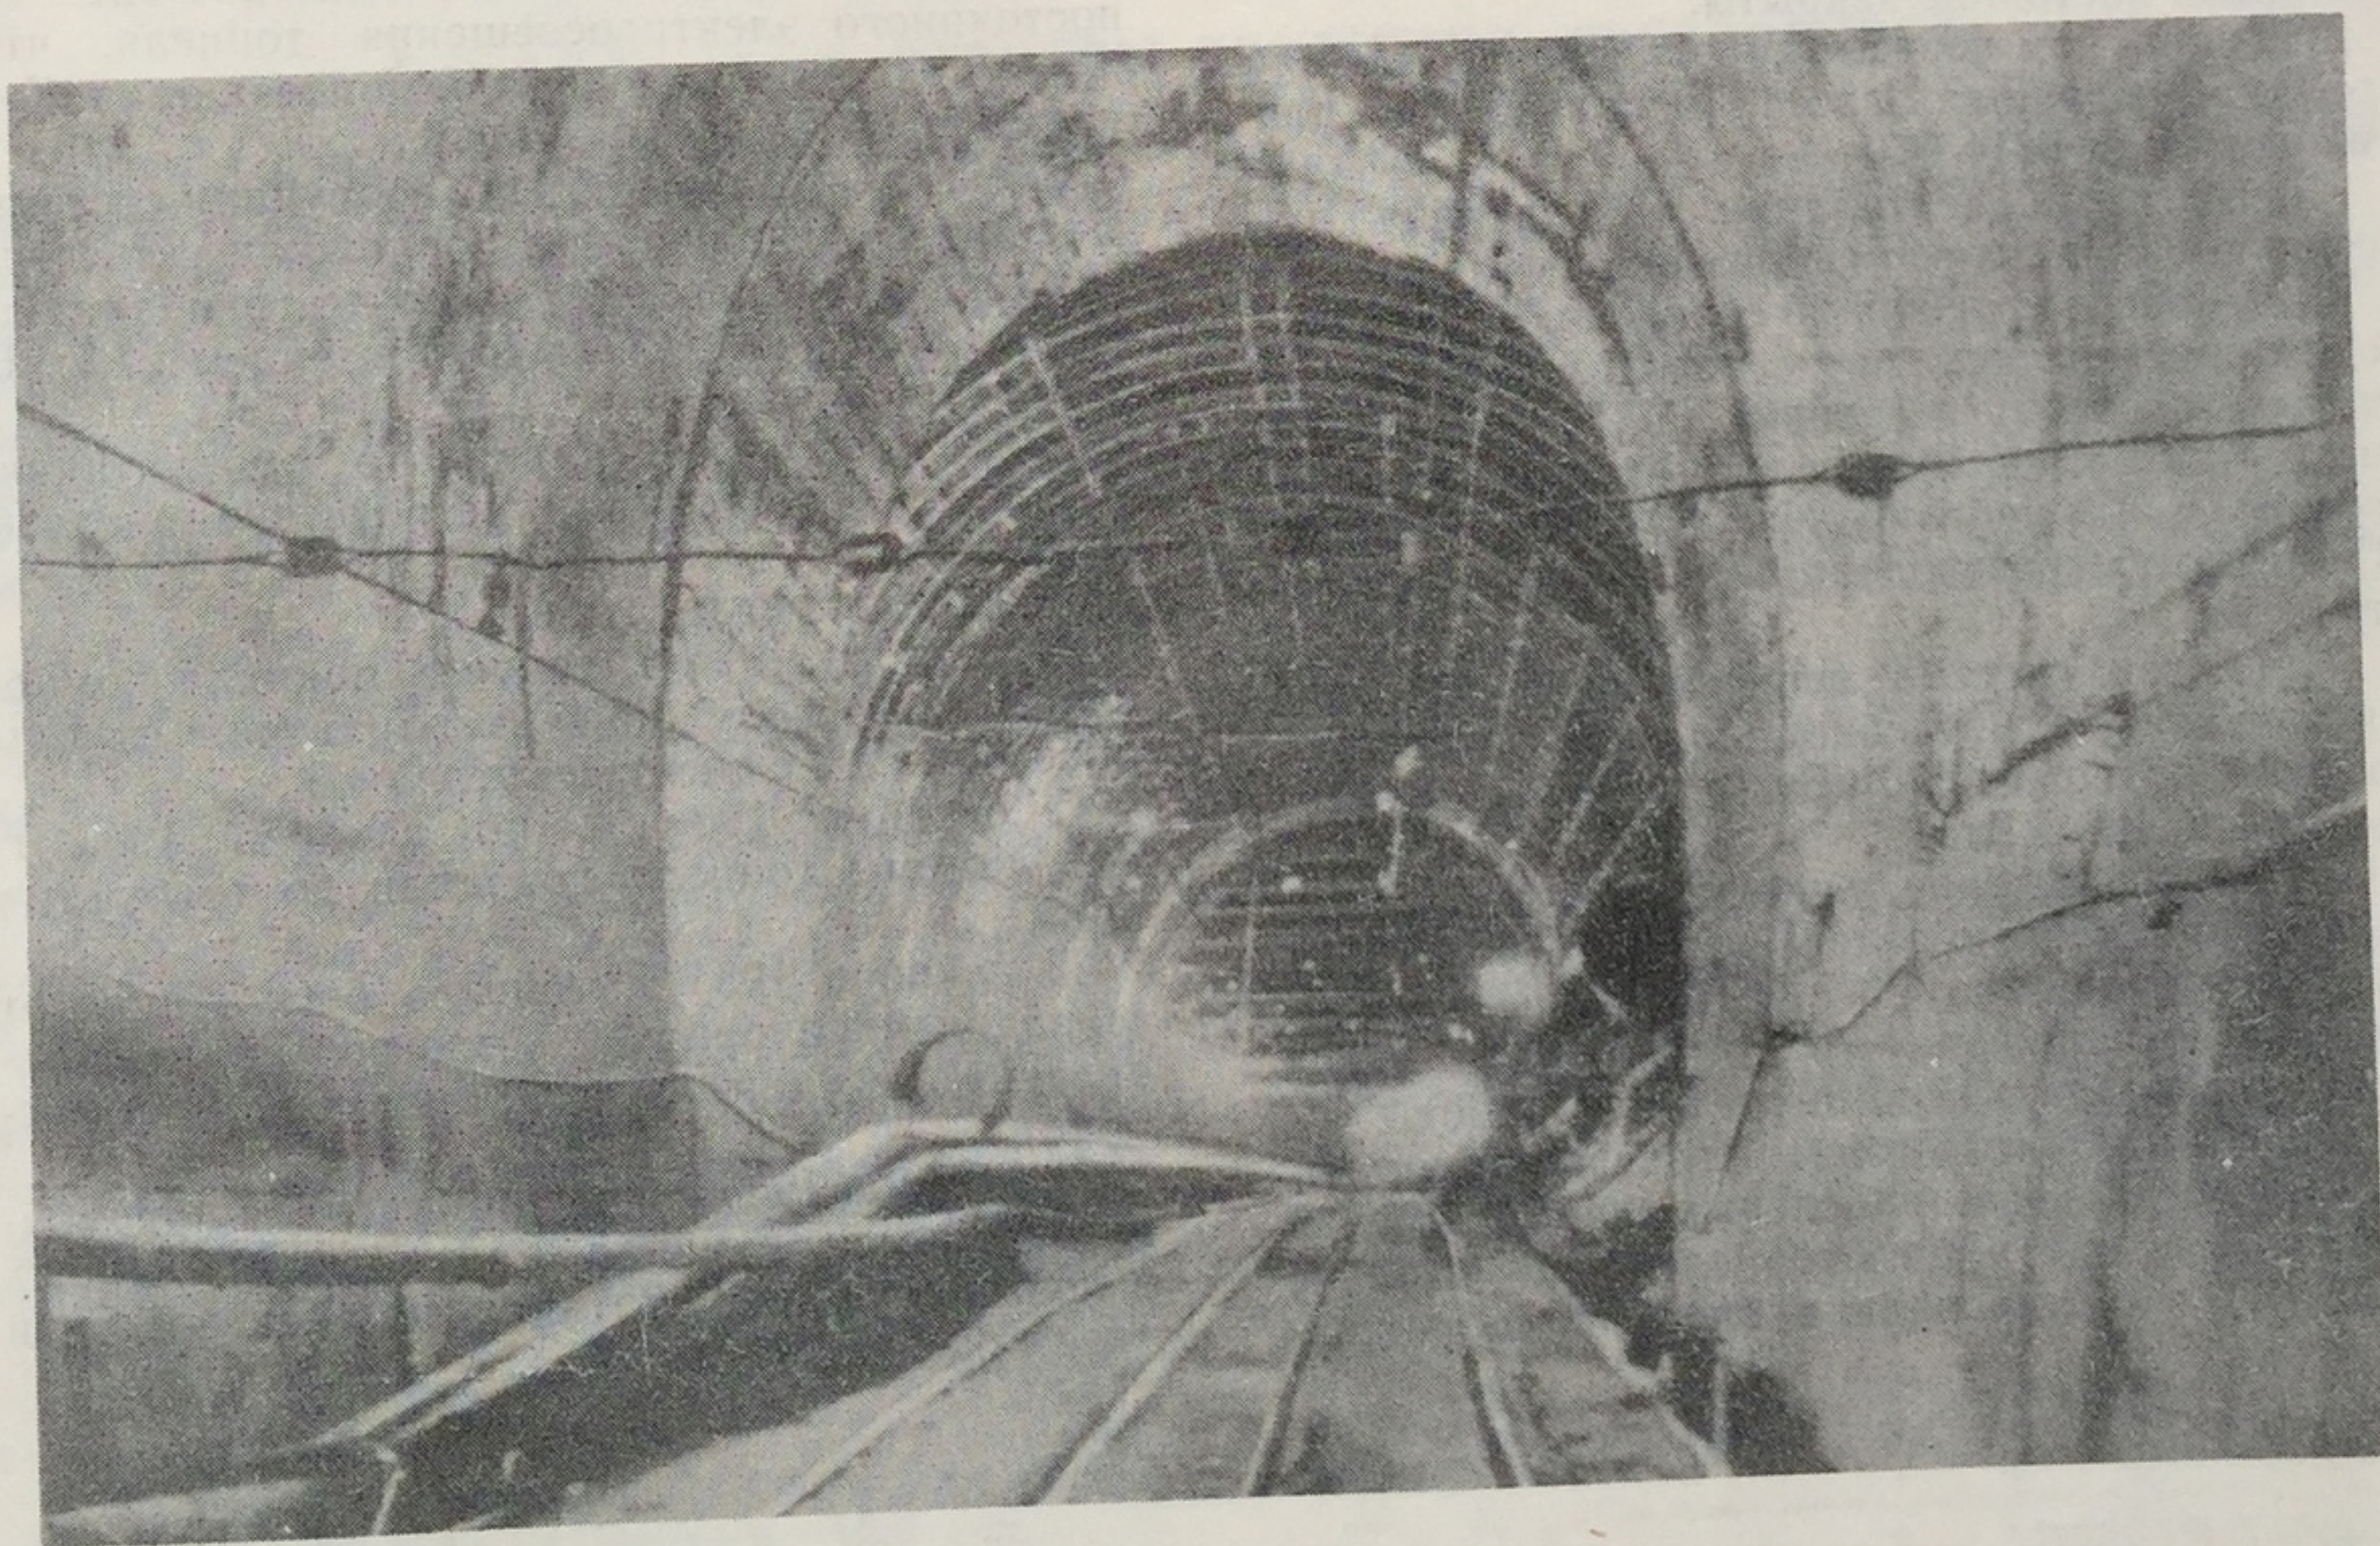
Постоянная бетонная обделка тоннеля
